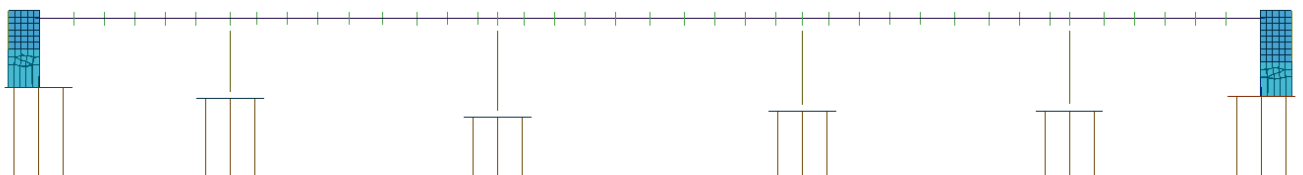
Modellazione tridimensionale Elementi finiti – prospetto longitudinale
